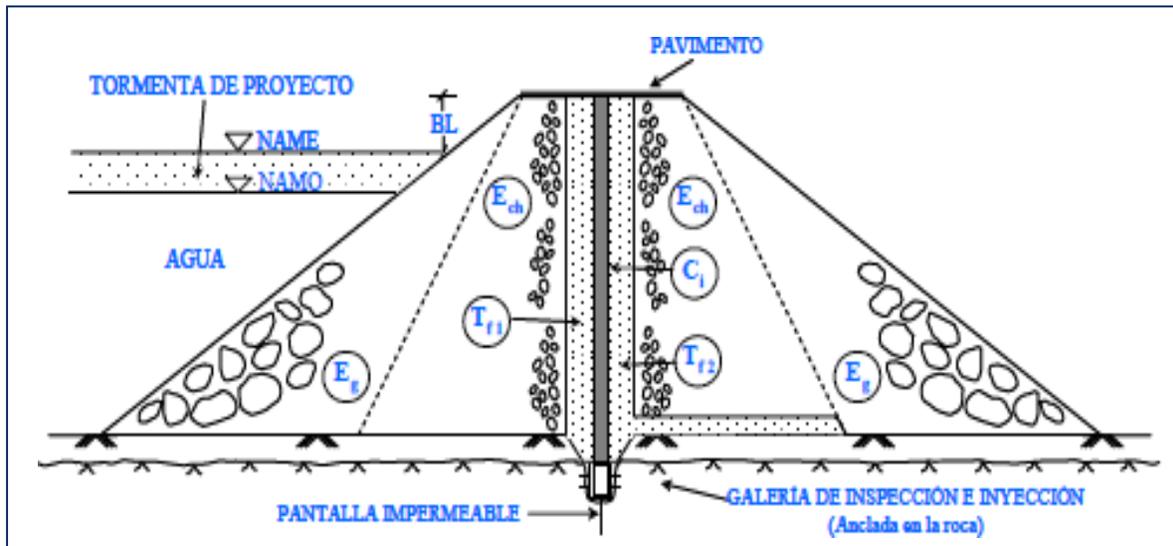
Corazón de concreto asfáltico de sección constante según la letra C₁
